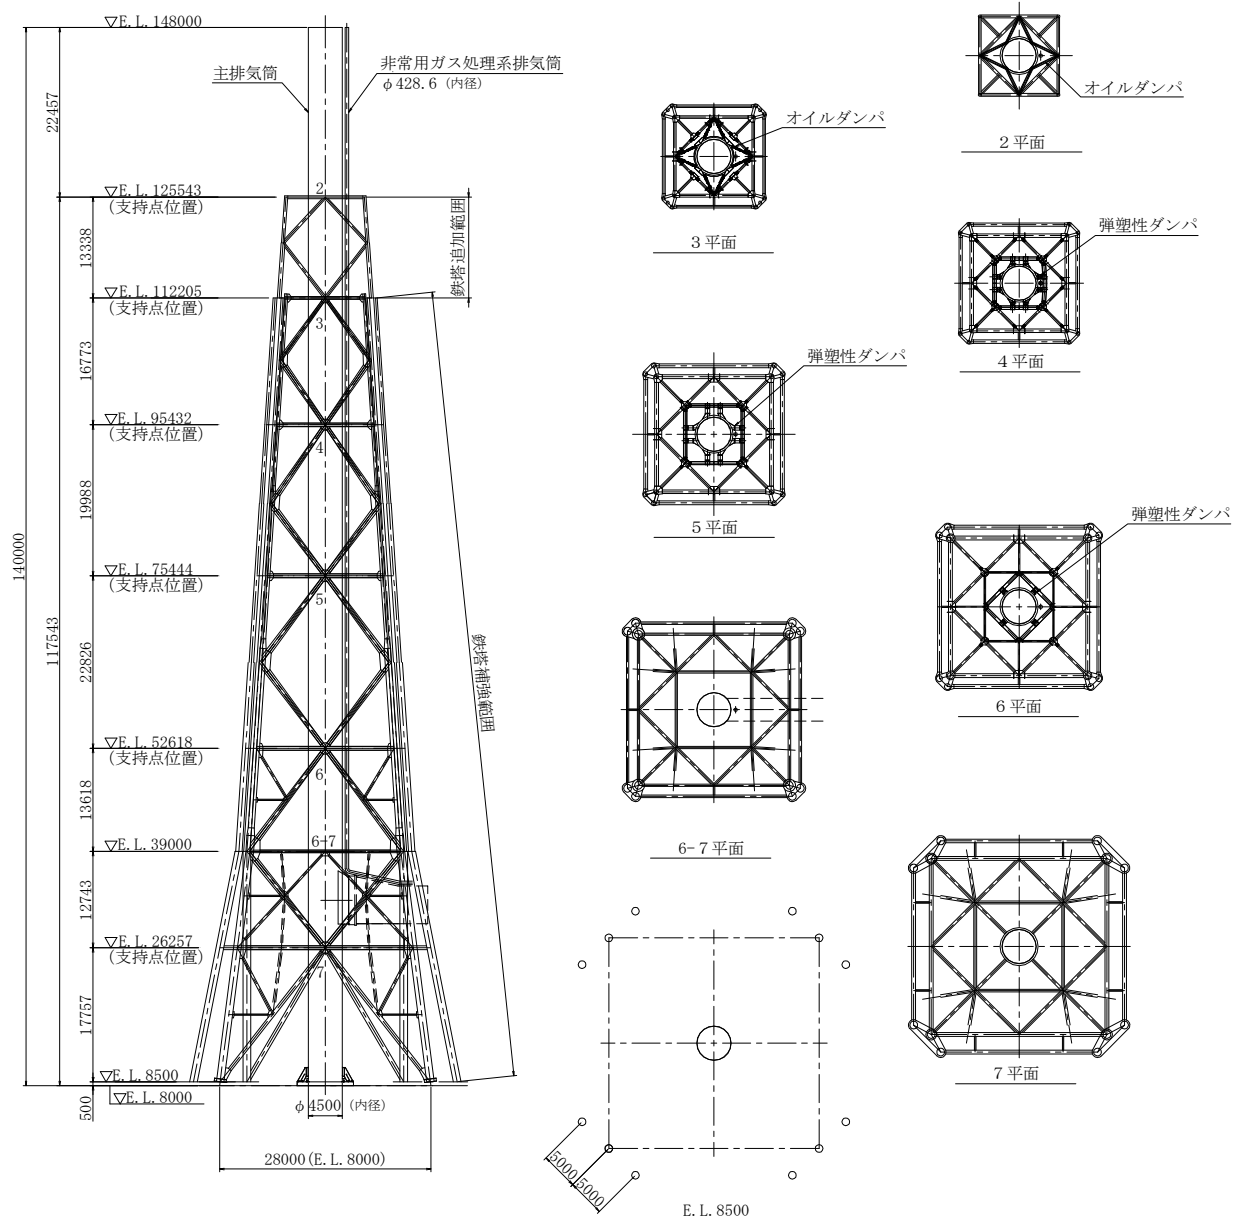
主排気筒の構造概要図 (単位 : mm)
